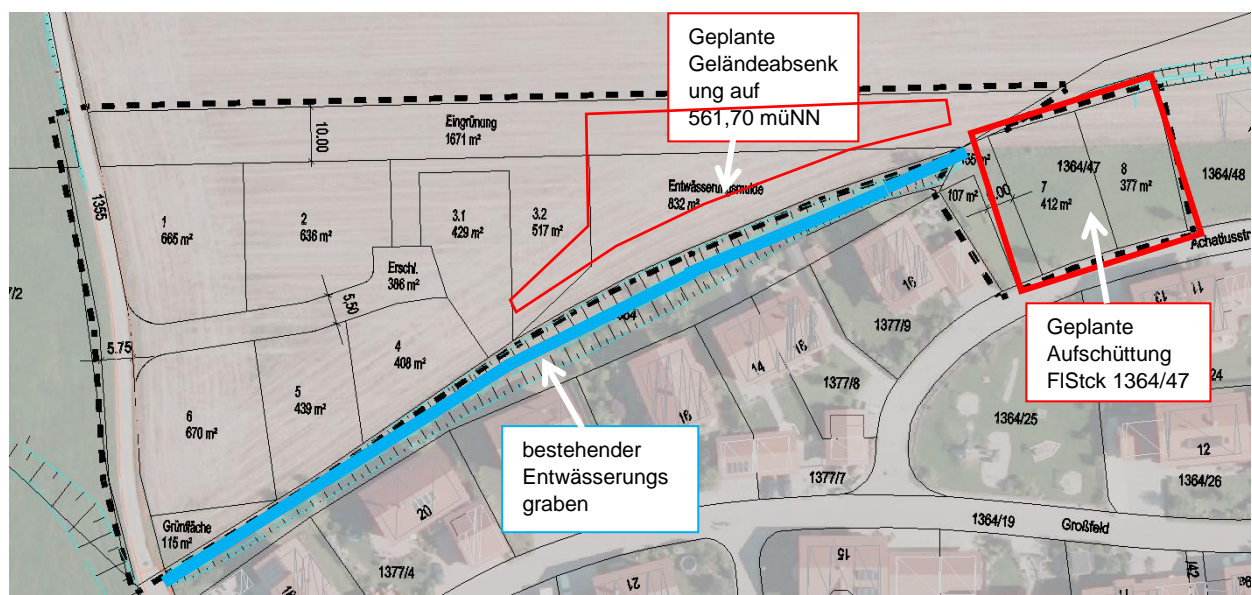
Lage bestehender und geplanter Retentionsflächen
